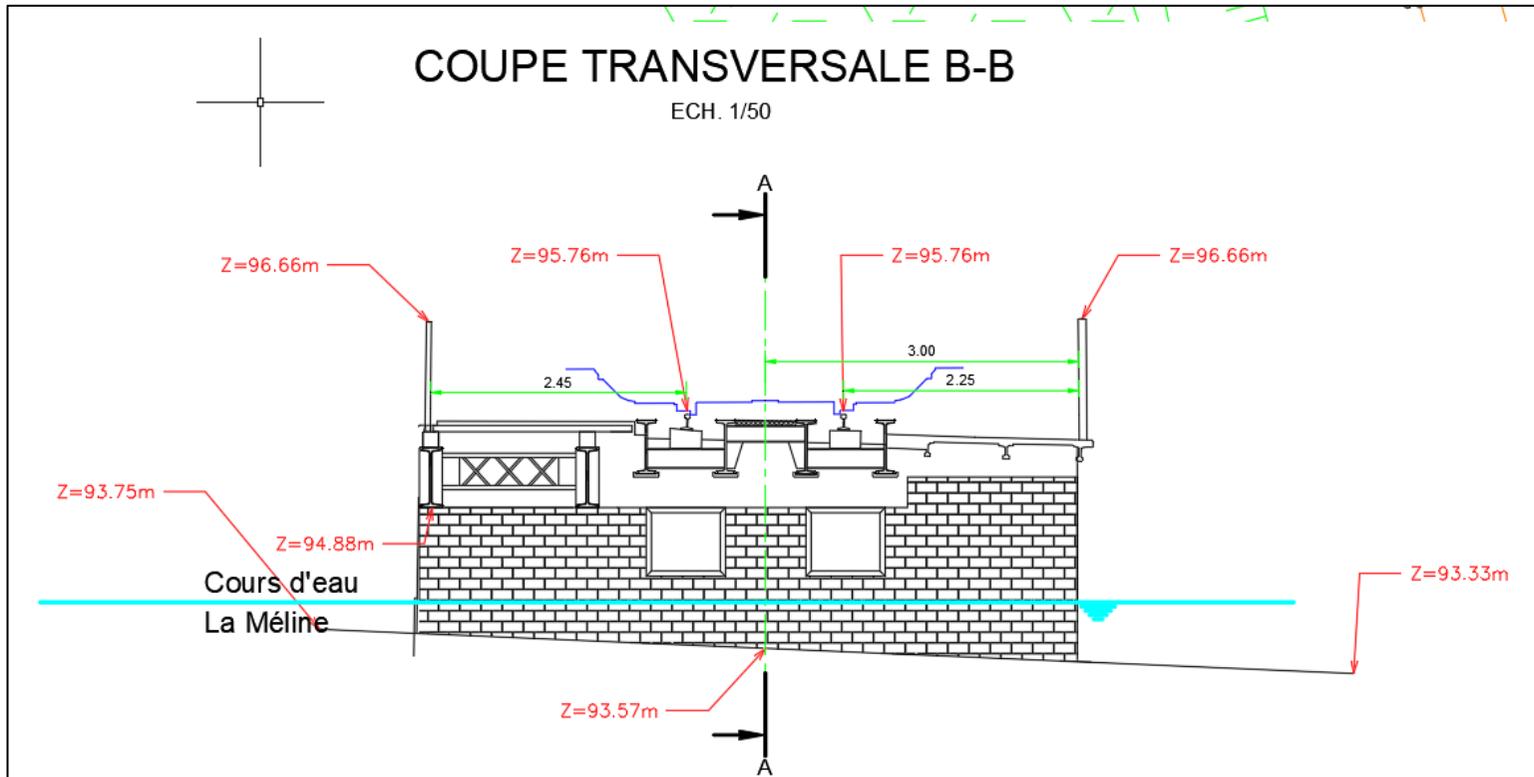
Coupe transversale du tablier existant du PRA situé au PK 142+268
